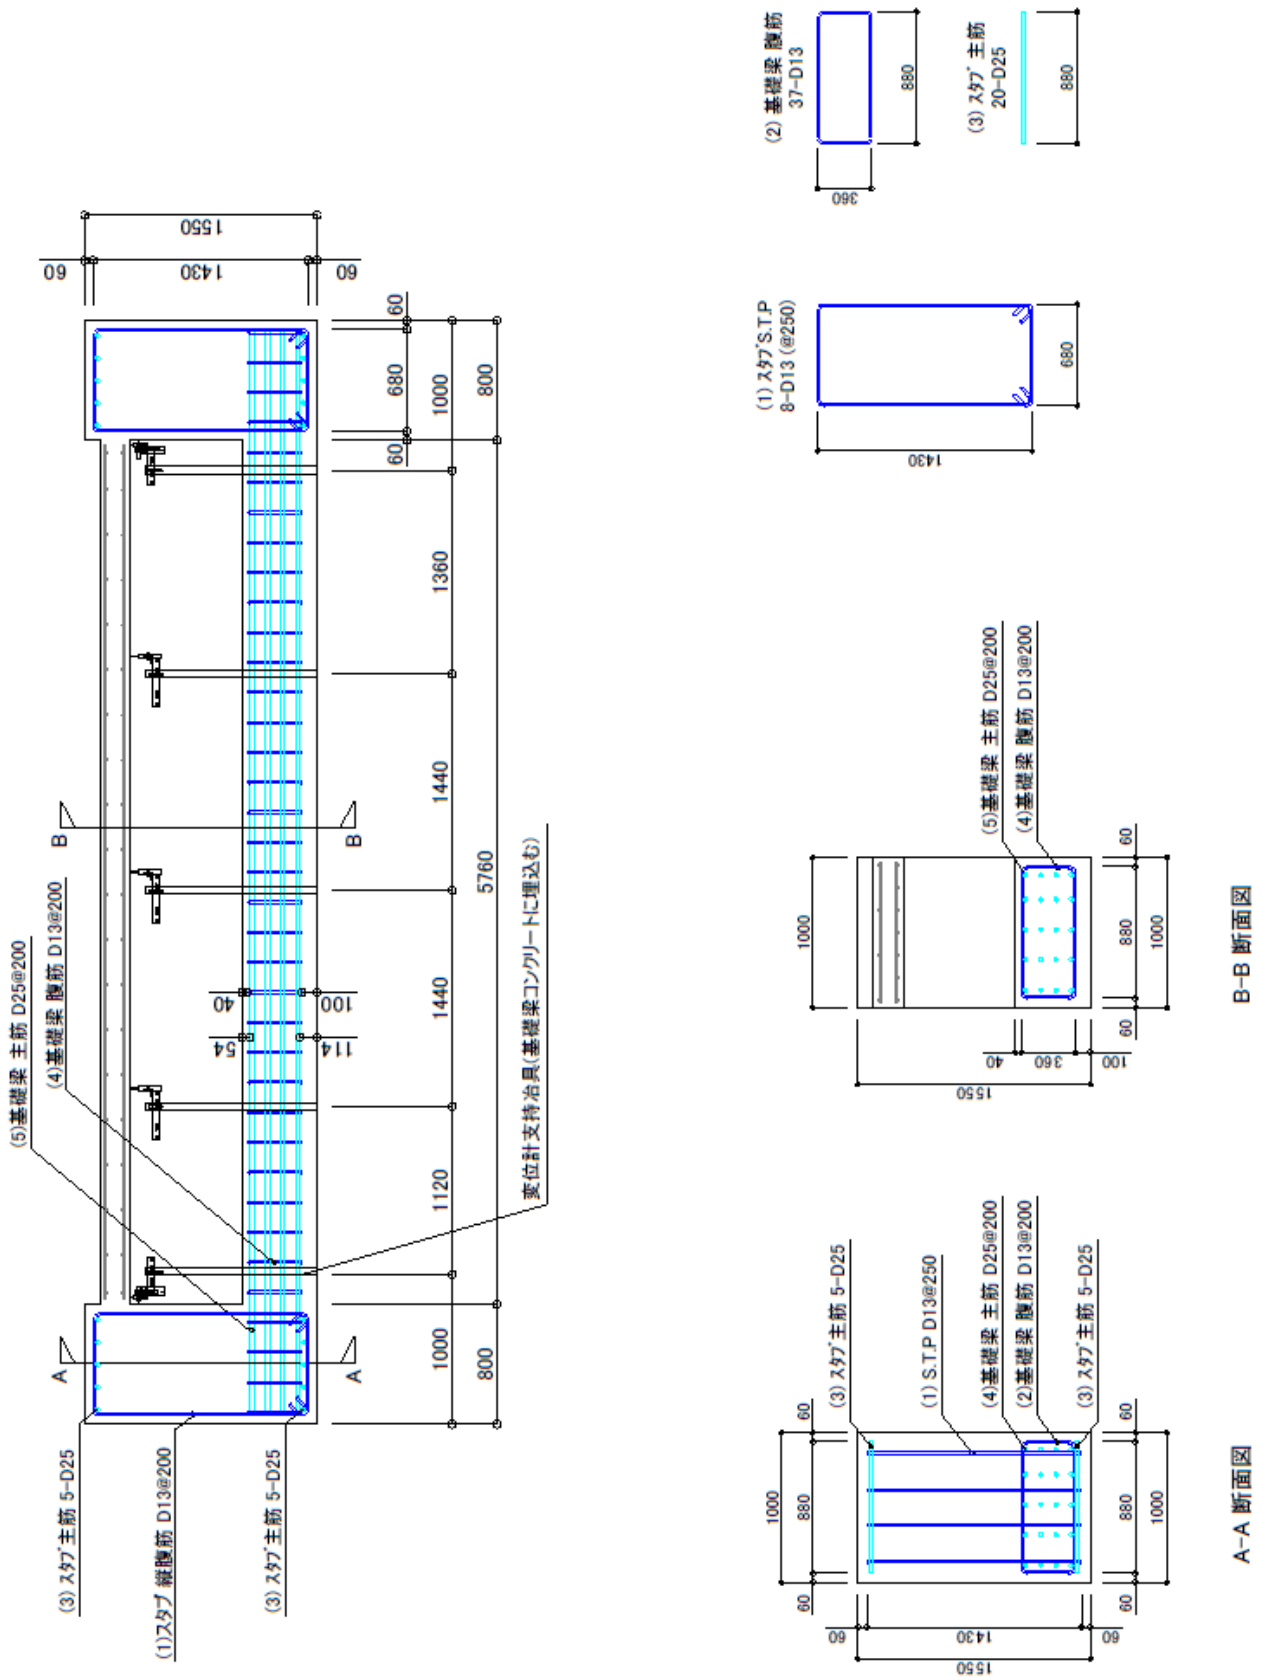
基礎梁・スタブ配筋図(AH, BA 試験体)
